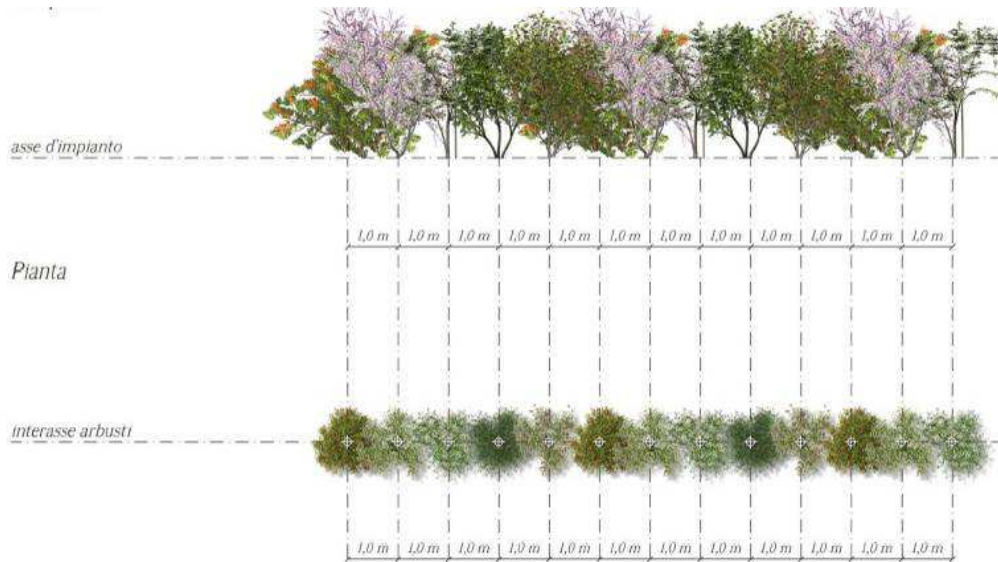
TIPOLOGIA A – PROSPETTO E PIANTA
